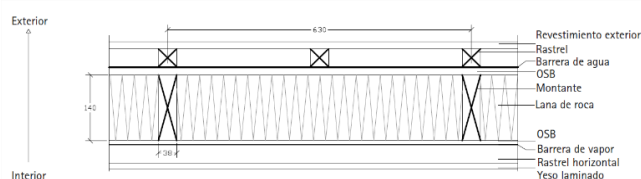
detalle en planta del revestimiento, Fuente: EGOIN
